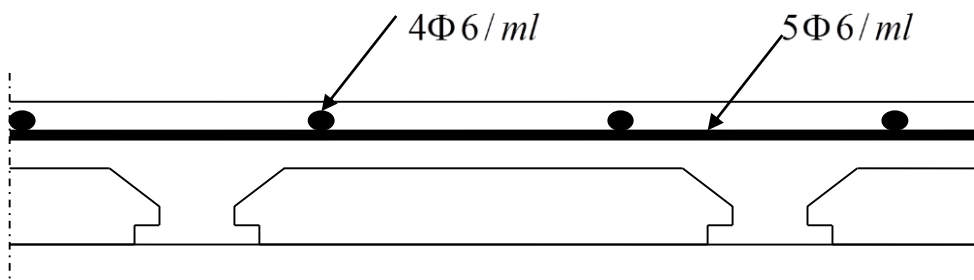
5 : Schéma de ferrailage de la dalle de compression.
